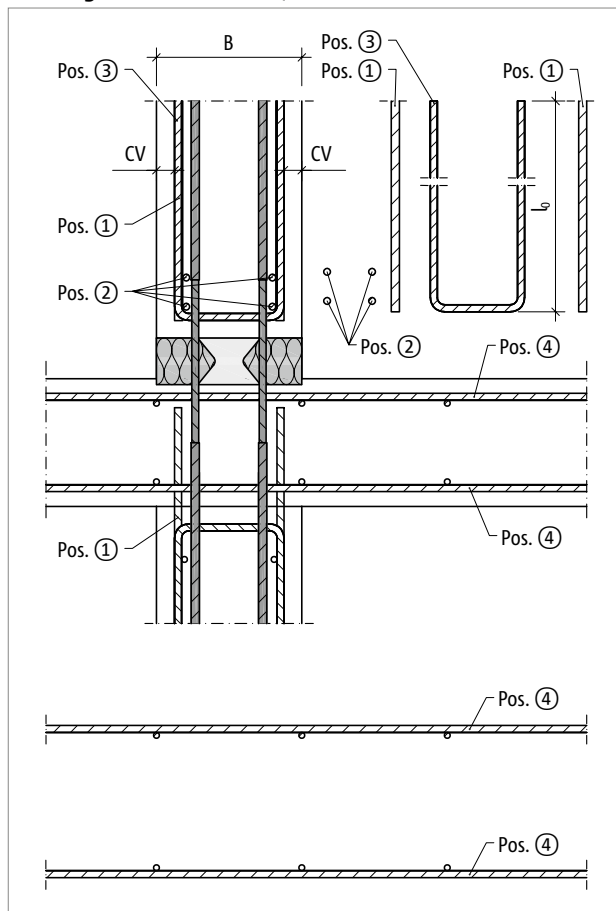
Schöck Sconnex® Typ W-NT-LW: Bauseitige Bewehrung bei Zugkraftverankerung
